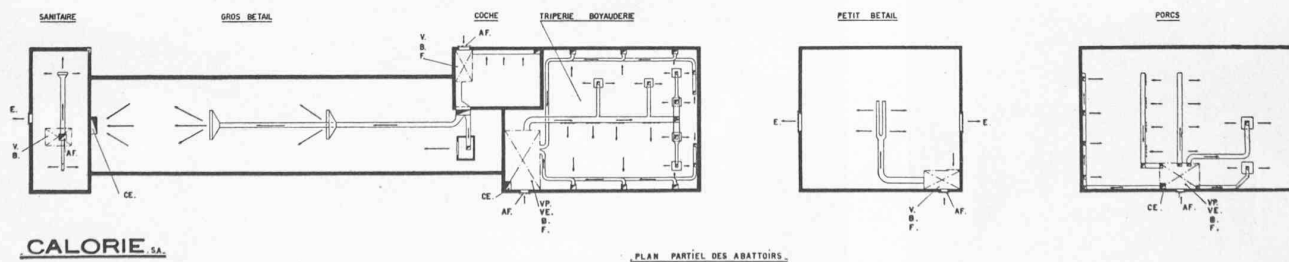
Halles d'abattage. Plan des installations de ventilation.
